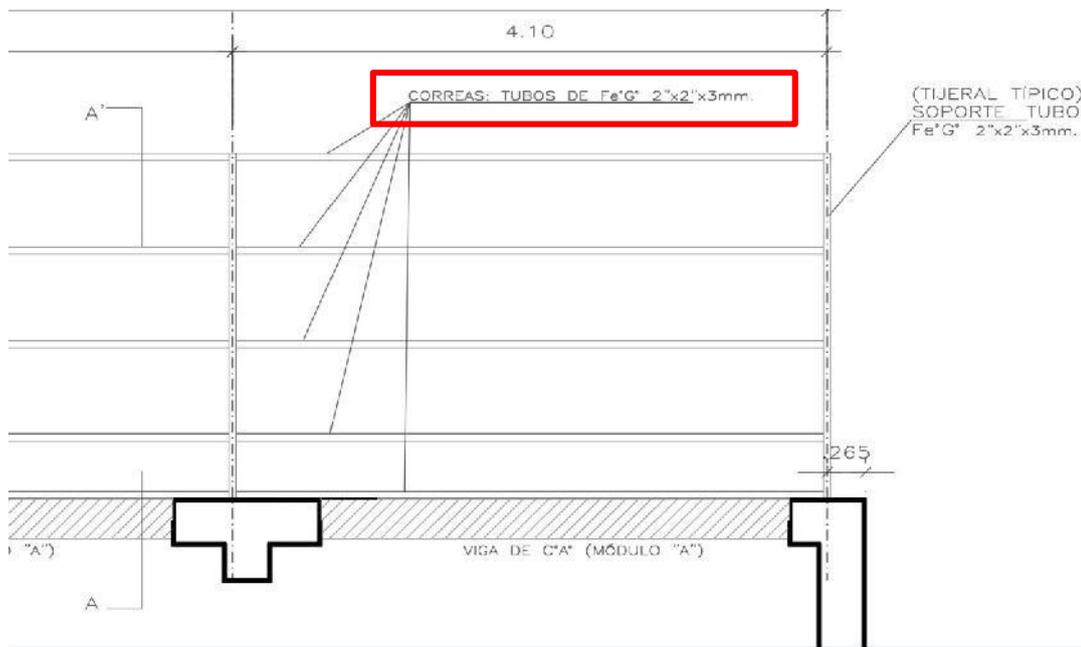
Zoom de detalle de vista en planta de cubierta tipo 01
